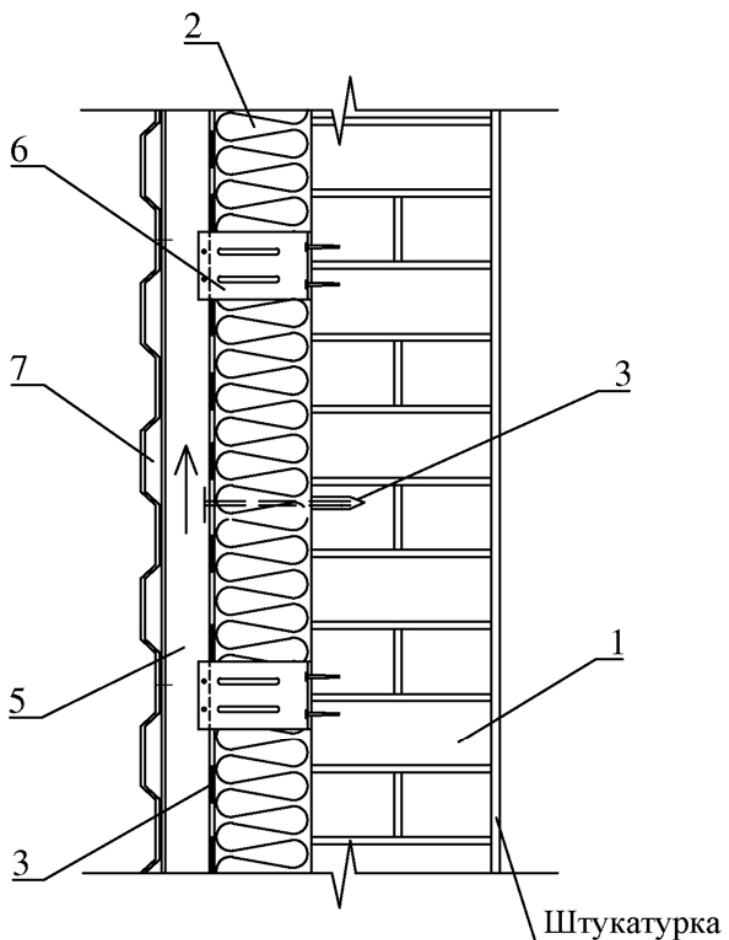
Утепление стен плитами ИЗОВЕНТ в конструкции вентилируемого фасада с облицовкой плитным материалом с применением крепления по системе "ДИАТ\*"
